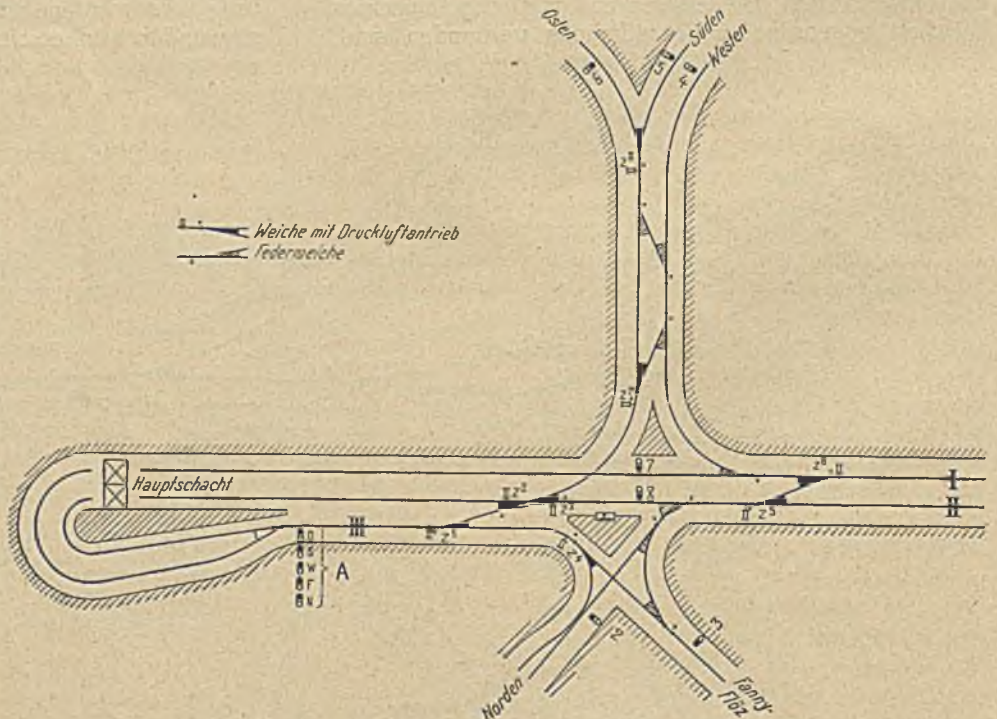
Grundrißliche Darstellung des Füllortes mit den Zufahrtstrecken und den Gleis-, Weichen- und Signalanlagen.
